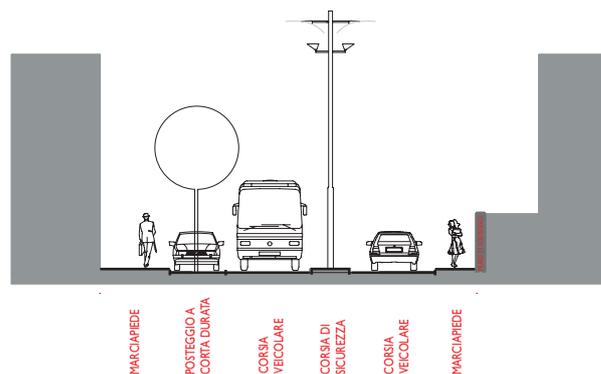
Nuova sezione stradale tipo (schema di sezione trasversale)
